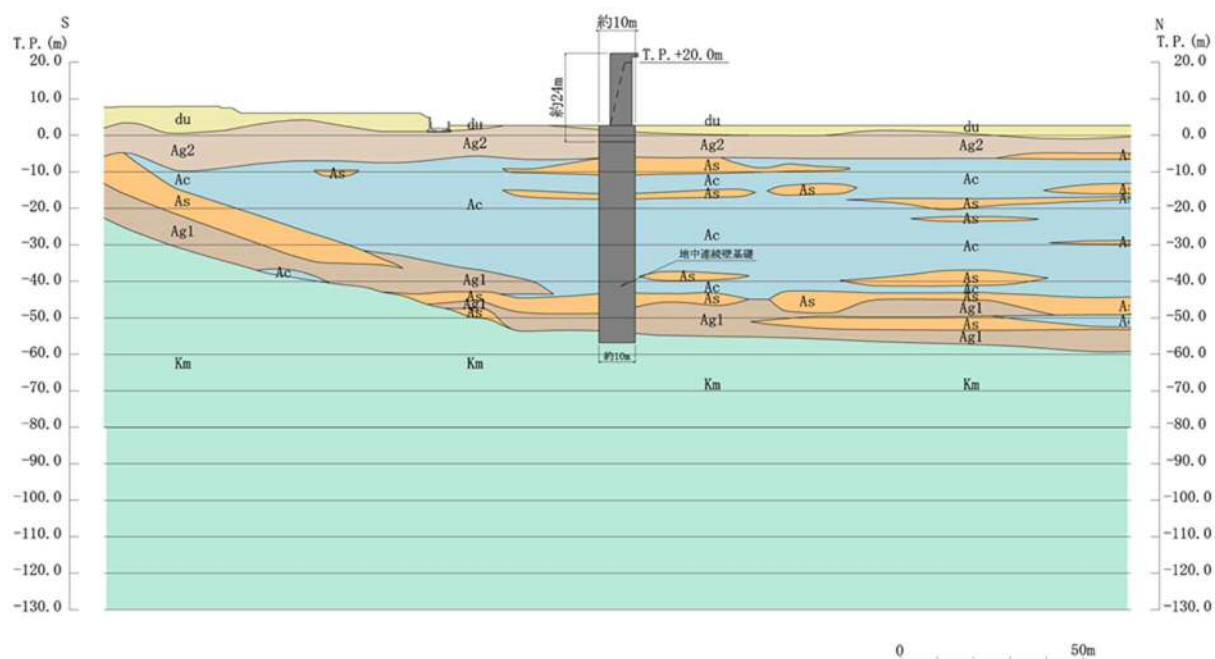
(1) 鉄筋コンクリート防潮壁 評価対象断面図 (①-①断面)
